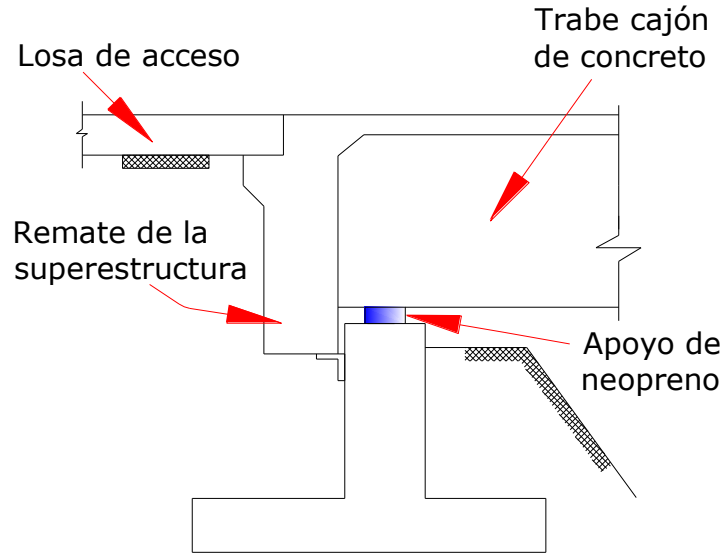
Estribo semi-integral, tipo antisísmico, con viga cajón de concreto y zapata de cimentación
